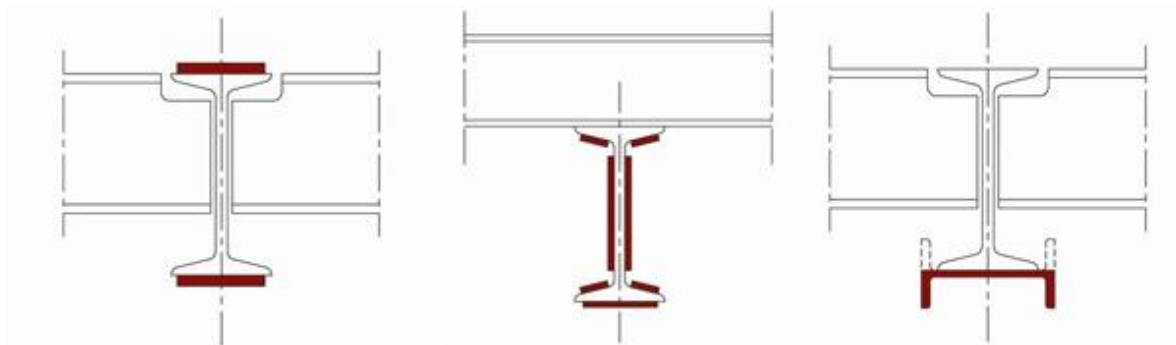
Ejemplo de reforzamiento por medio de placas y/o perfiles metálicos
